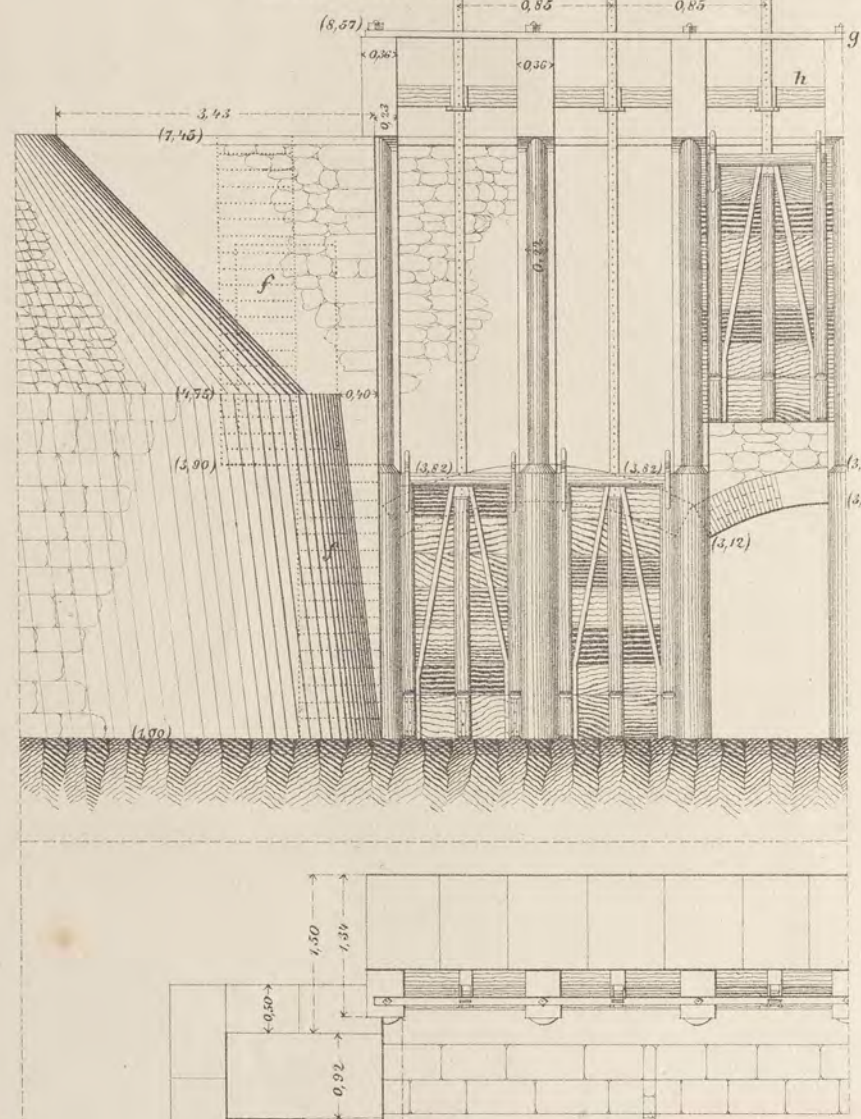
<sup>a</sup> Elevazione a valle e sezione C-D di una parte del derivatore.
